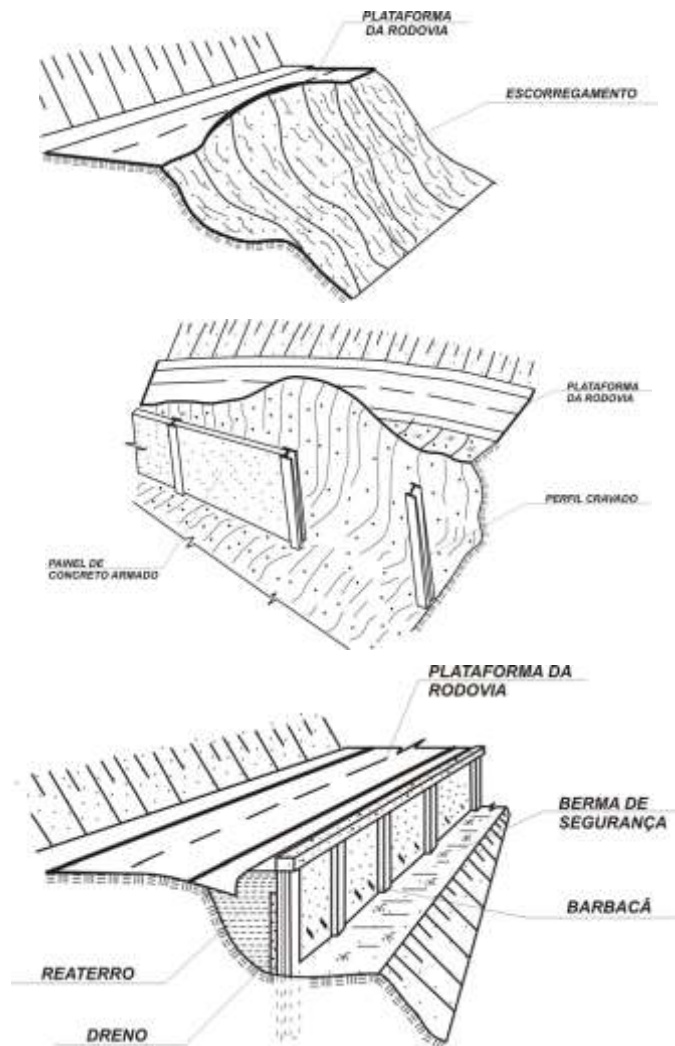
Projeto tipo 14 – Cortinas cravadas.
